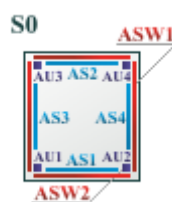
Расположение и вид арматуры в сечениях элементов фермы
